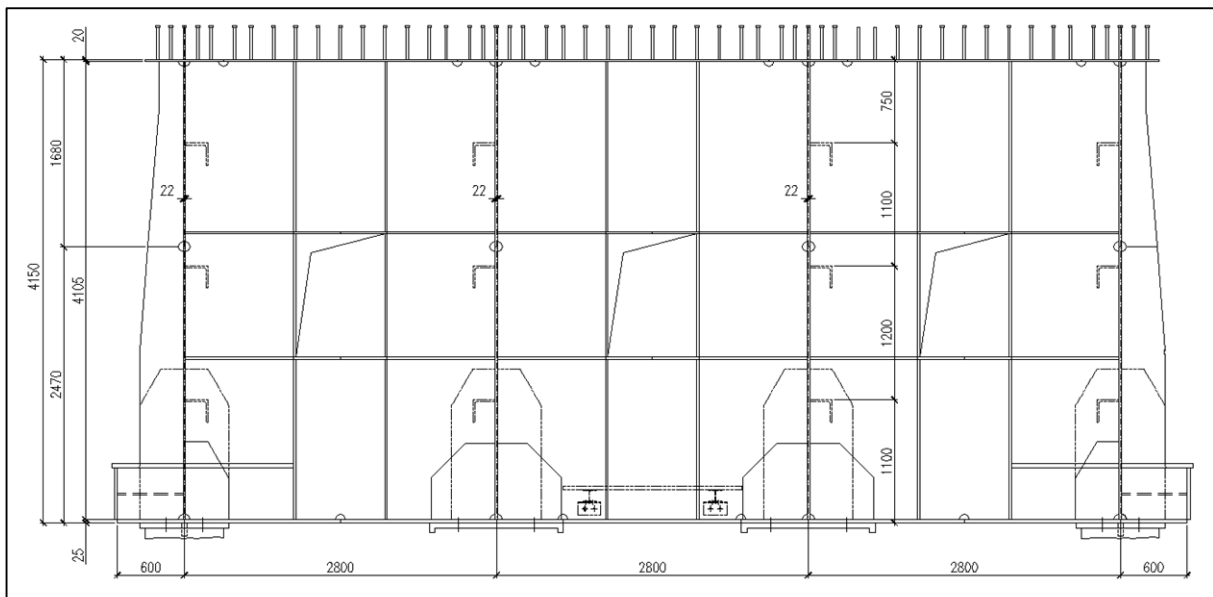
Progetto Esecutivo - Sezione in appoggio
